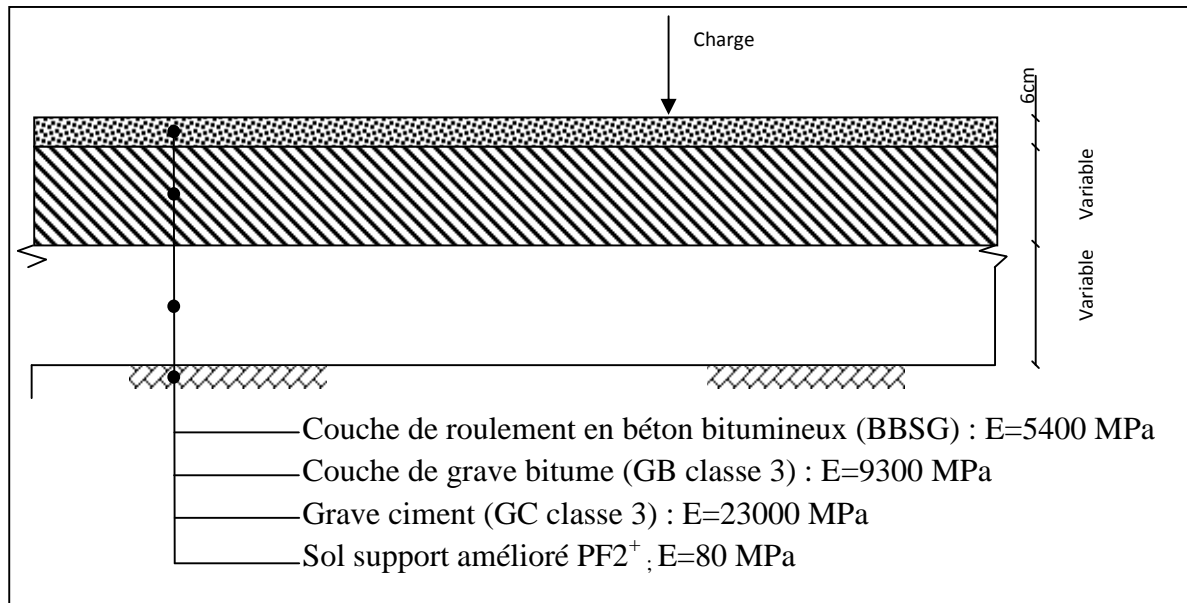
Coupe typique d'une chaussée semi-rigide
